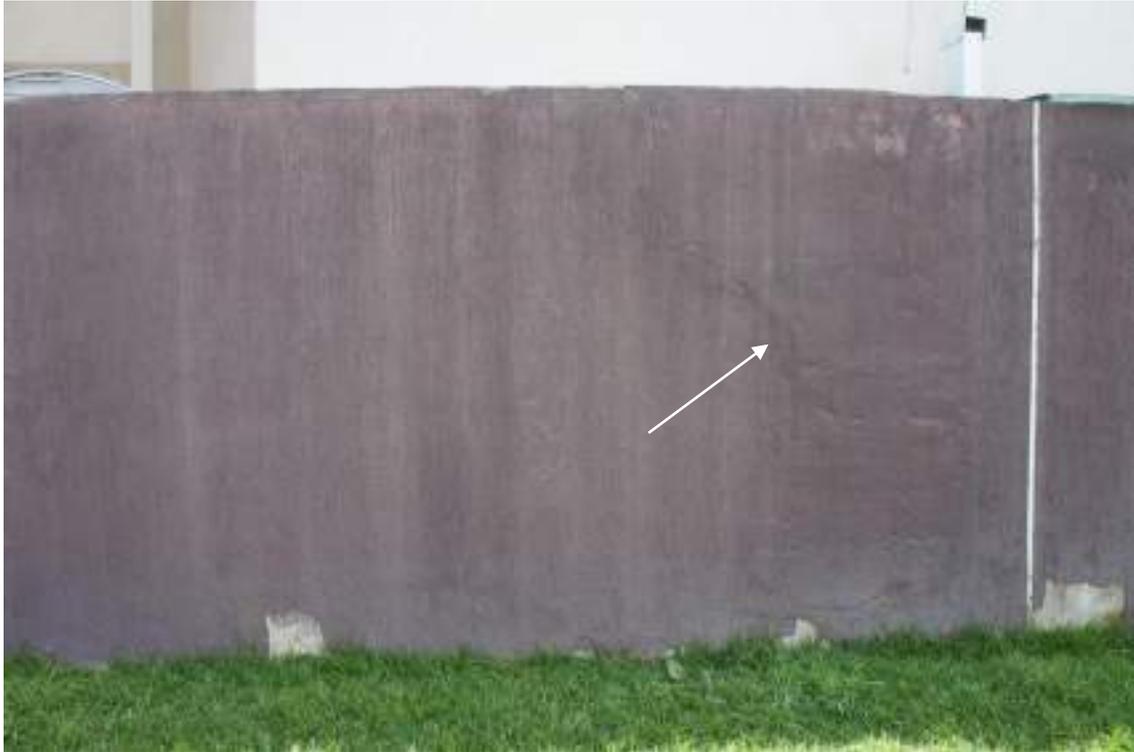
Fachada posterior, afectaciones muro cerramiento patio posterior, Septiembre 2022
